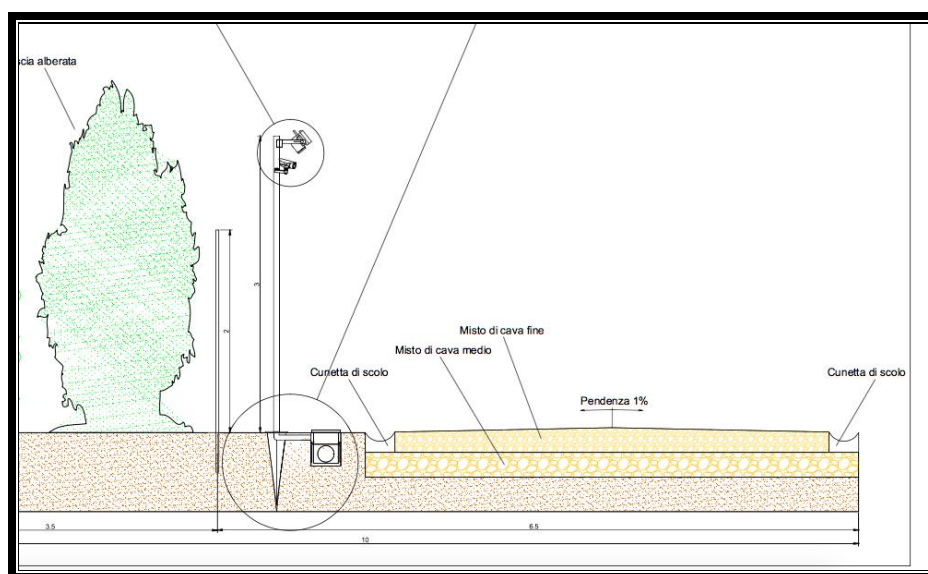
SCHEMA DEL PROGETTO DI MITIGAZIONE
